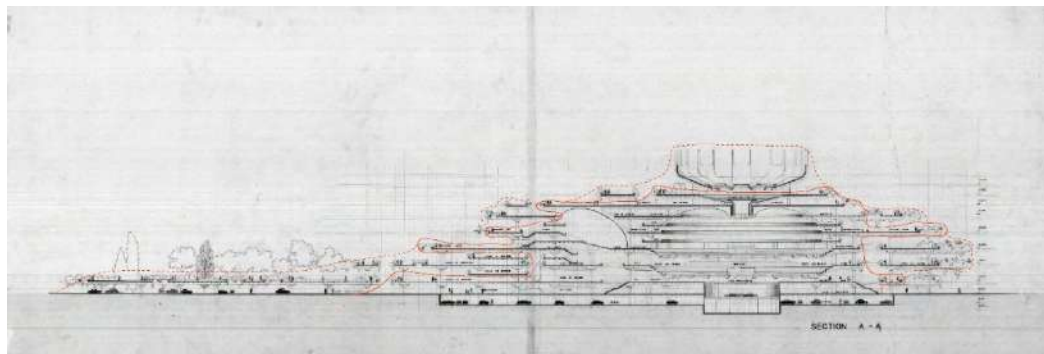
Ejercicio propio de trazo de la envolvente sobre la planimetría original del proyecto.
